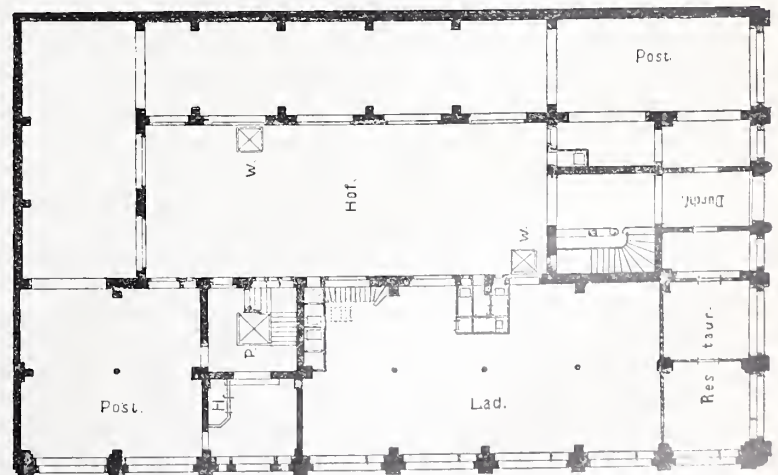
Erdgeschoss-Grundriss vom Kaufhaus Joseph in Berlin. 1:400.
